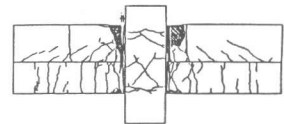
No.2(構造目地なし) 最終ひび割れ状況
